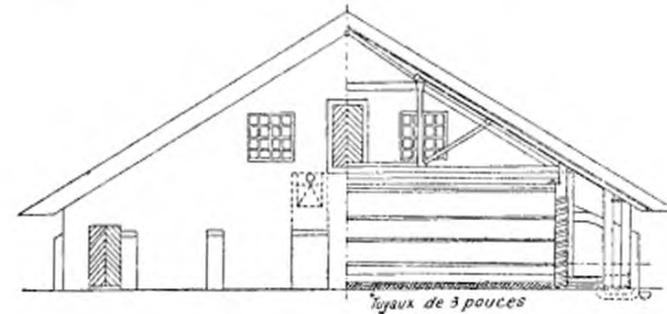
(c). — Demi-élévation et Demi-coupe transversale suivant AB du plan et suivant CD du plan.
